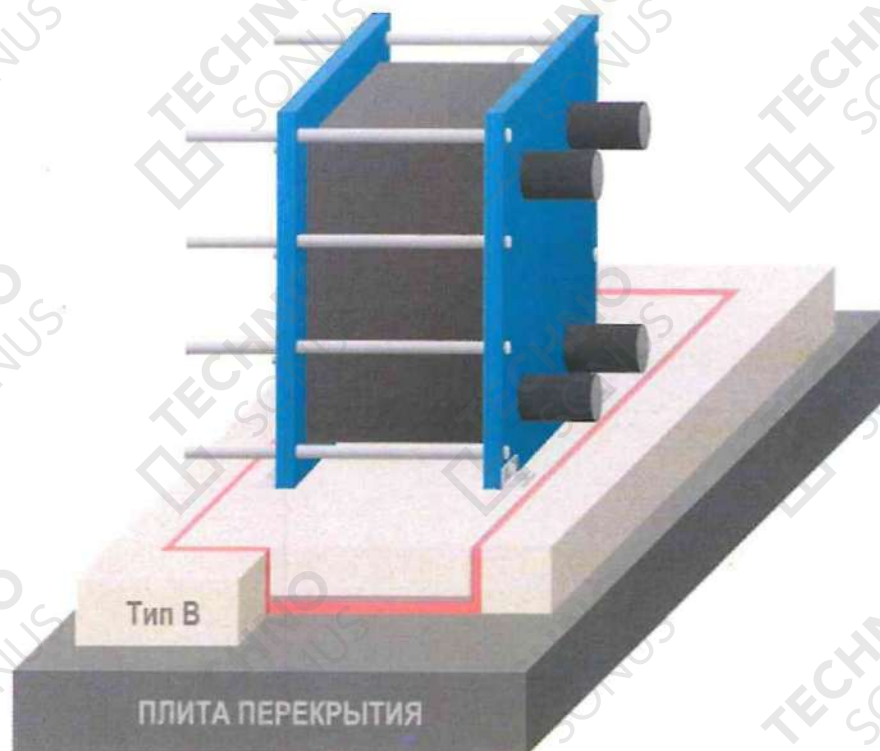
Типовое решение системы виброизоляции с применением полноплоскостной раскладки (тип В.1) виброизоляционного материала в конструкции плавающего фундамента.
